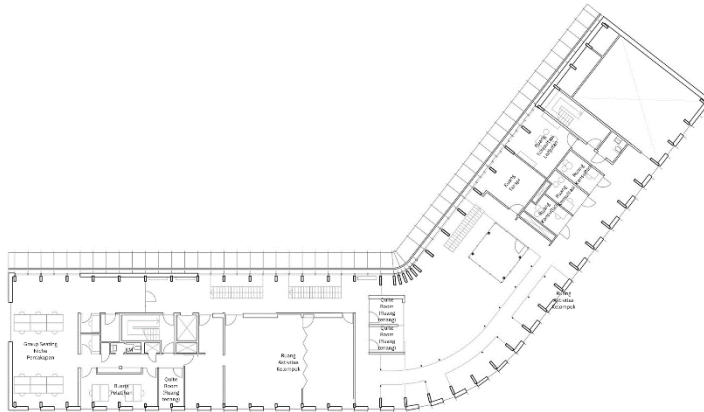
Ground Floor Plan Center for Health, Copenhagen, Denmark
